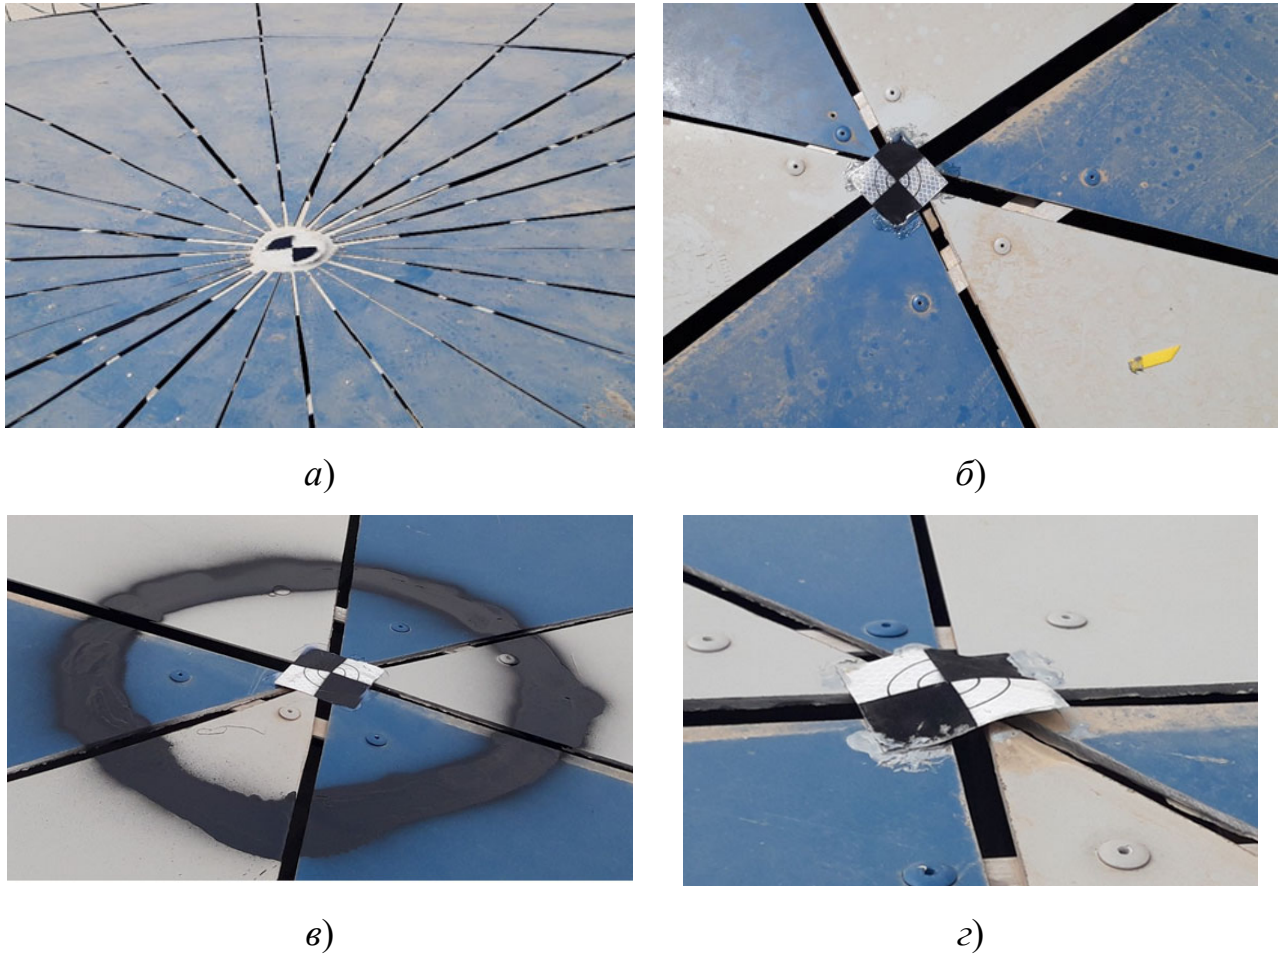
Маркировка контрольных точек на перекрытии
